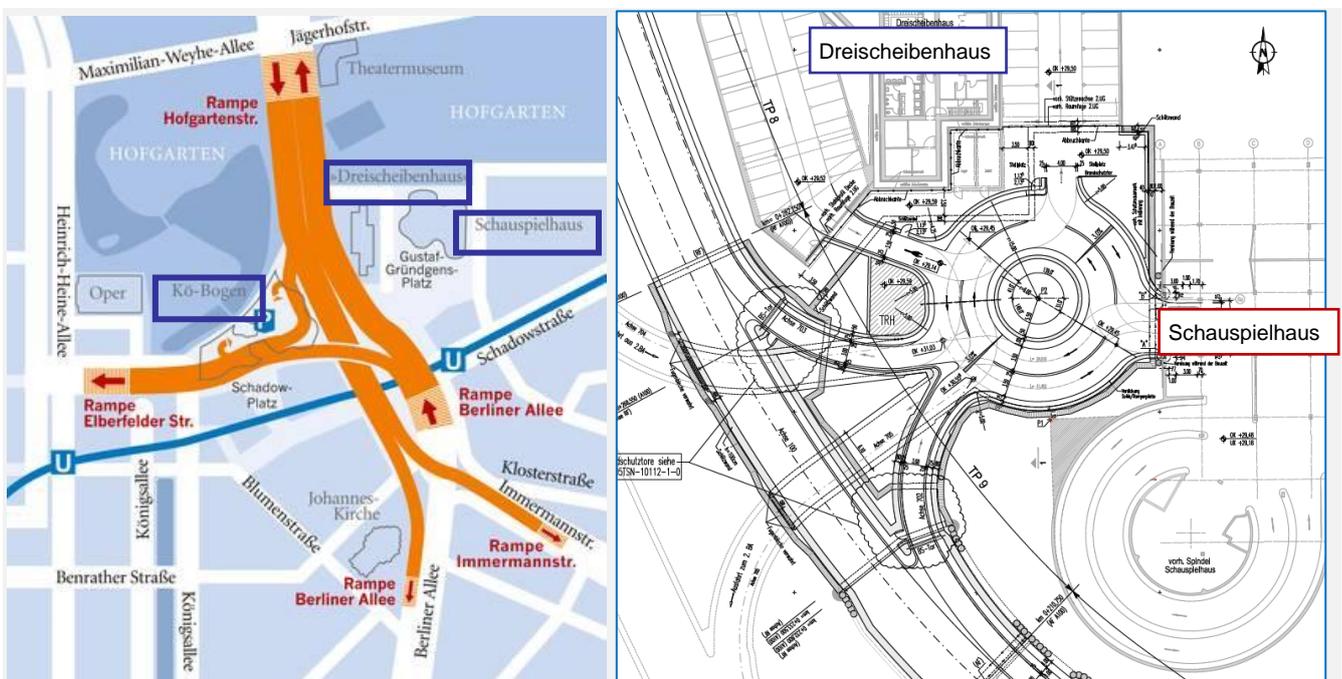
Tunnel de Kö-Bogen et rampe hélicoïdale souterraine d'accès aux parkings
